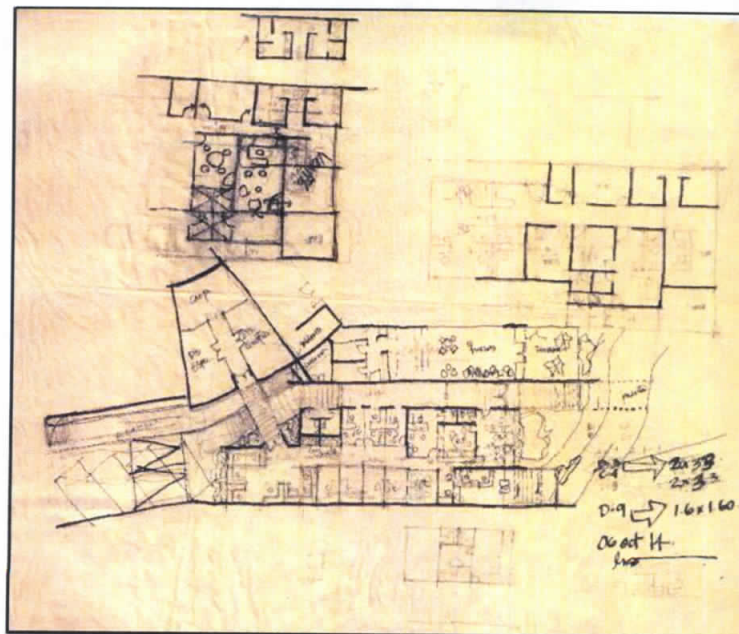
Croquis de propuesta final de planta de Talleres y administración. (FUENTE: Coordinación de Vinculación y Proyectos Especiales, Facultad de Arquitectura 2014)
